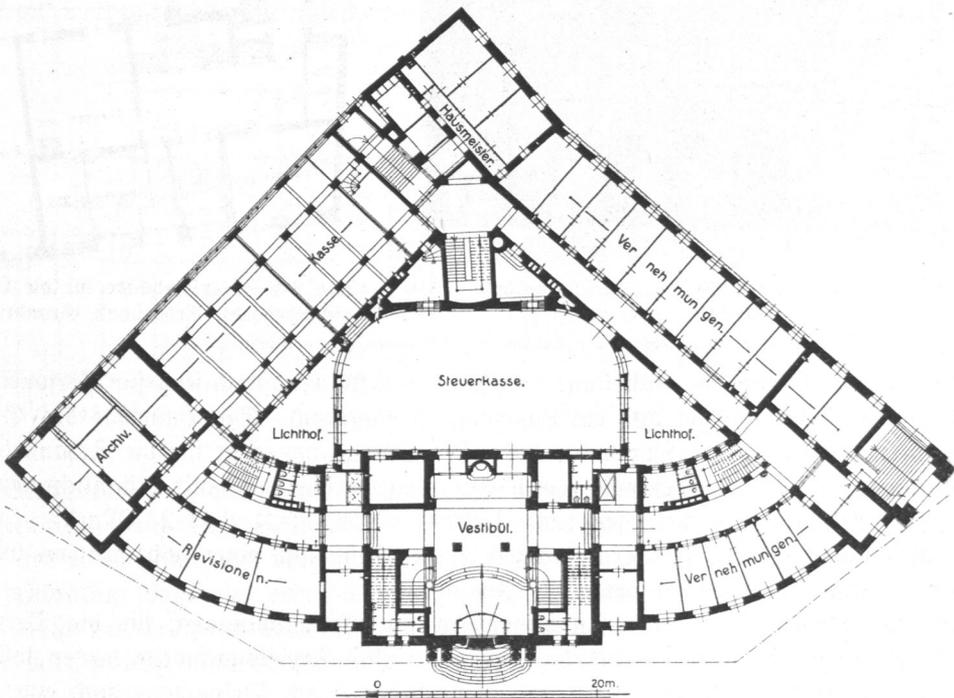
Steuergebäude, Grundriß, Erdgeschoß.
